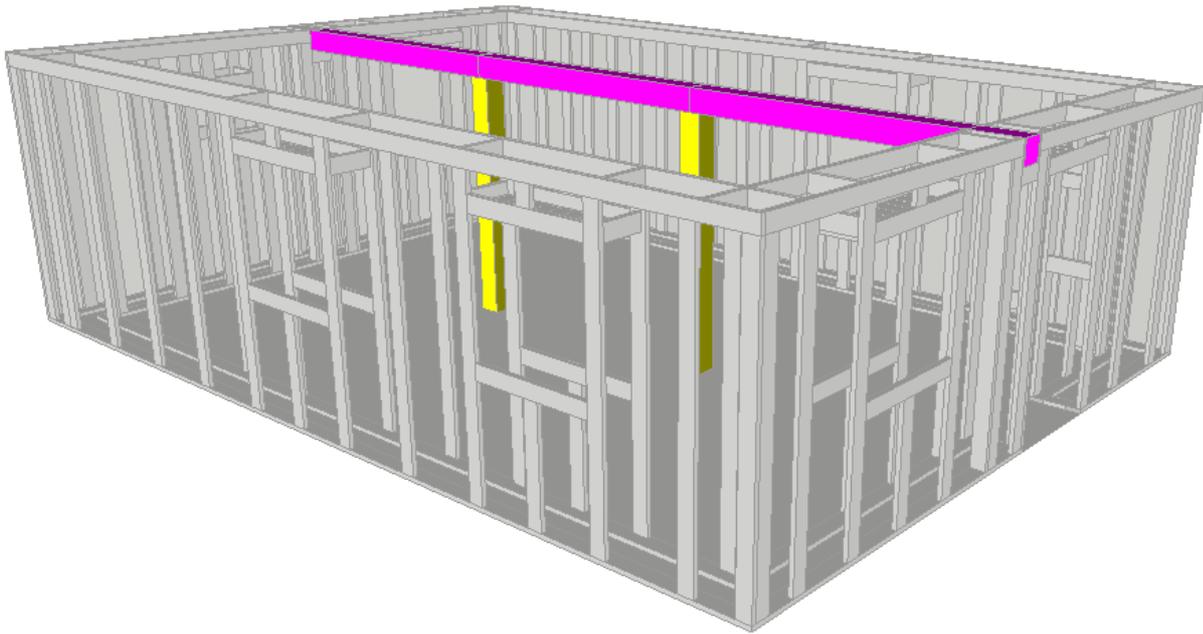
Poteaux de soutènement (en jaune) et fermes (en mauve).
